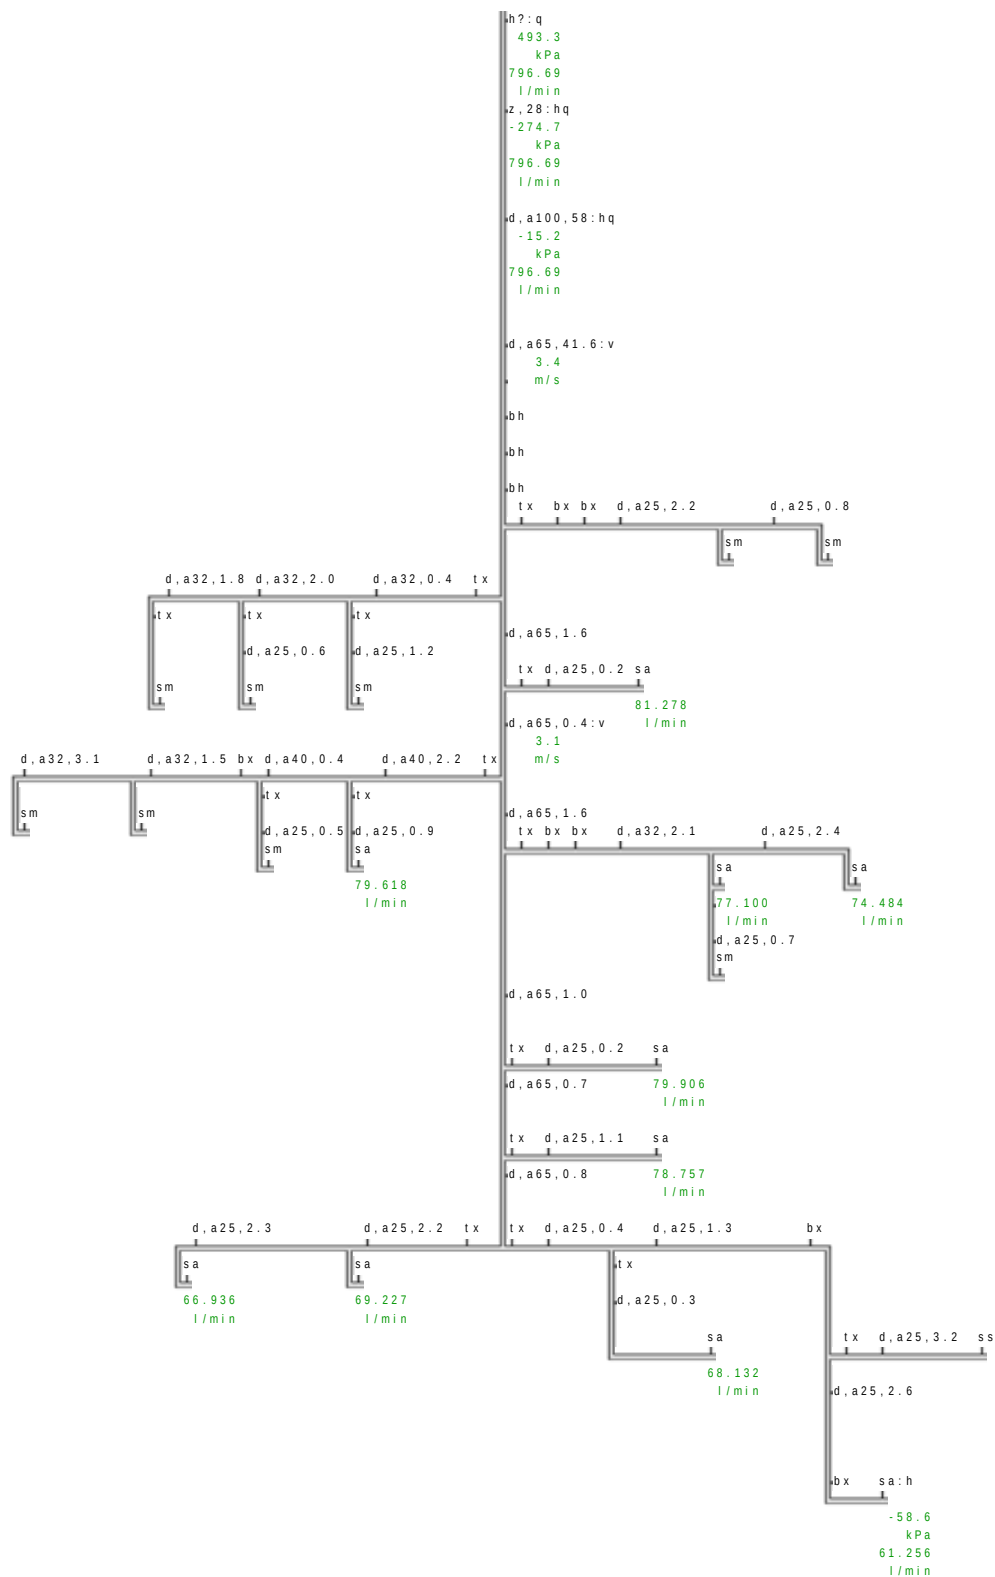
22 Sprinklerritningar för hus 20 plan 5.
